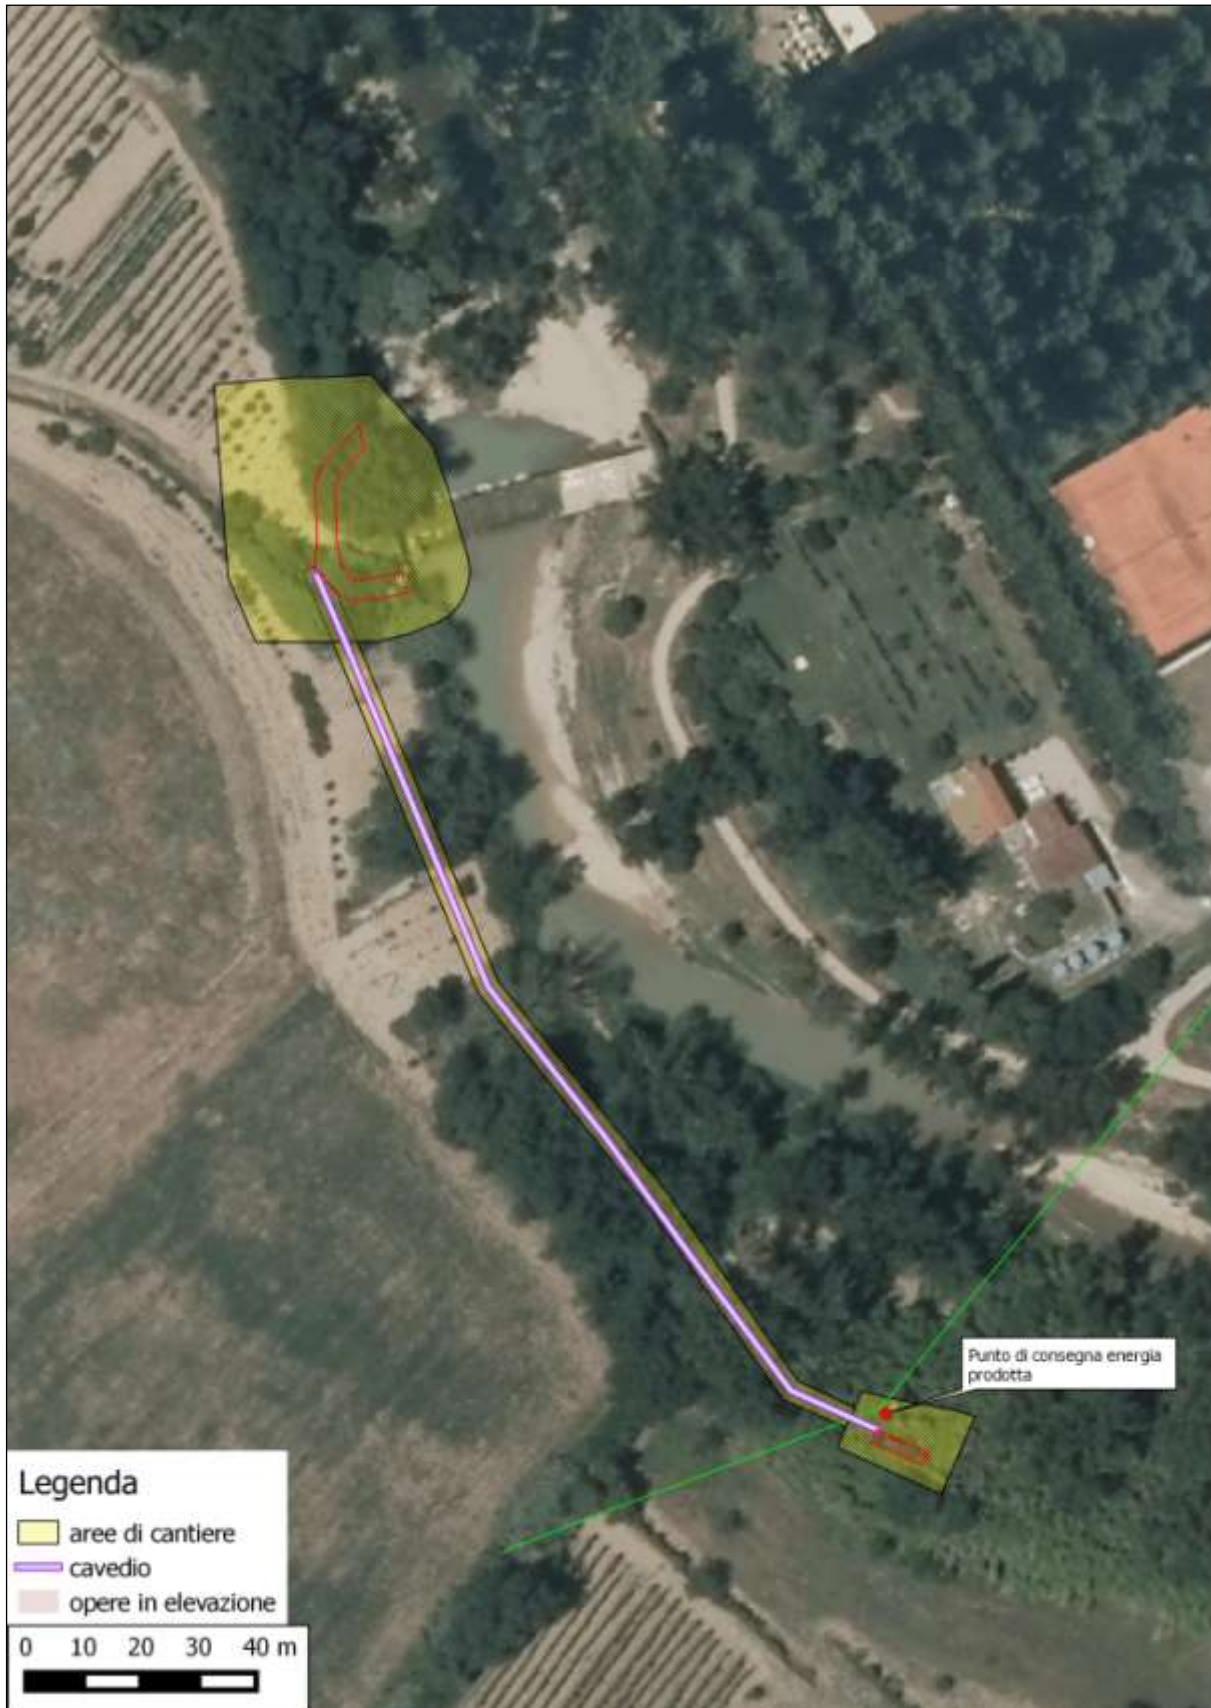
Aree occupate temporaneamente dal cantiere e aree occupate in modo permanente dalle opere in progetto (rosso).
